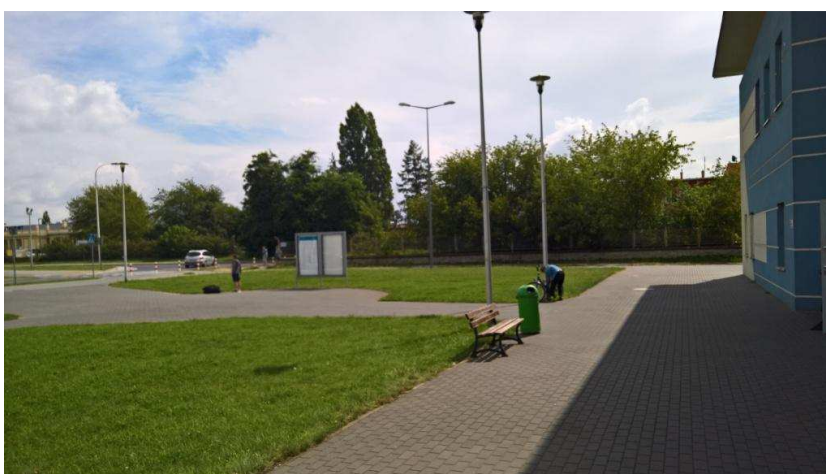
Zagospodarowanie terenu przed dworcem PKS, widok w kierunku południowym, tablica ogłoszeniowa, elementy małej architektury
